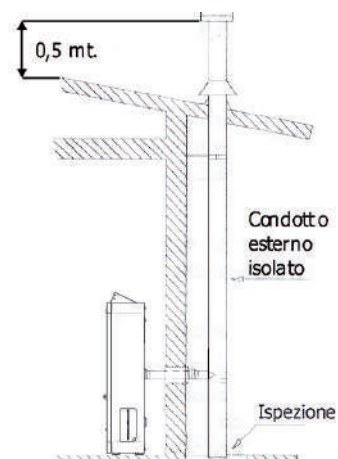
collegamento ad un condotto esterno con tubo isolato o doppia parete
